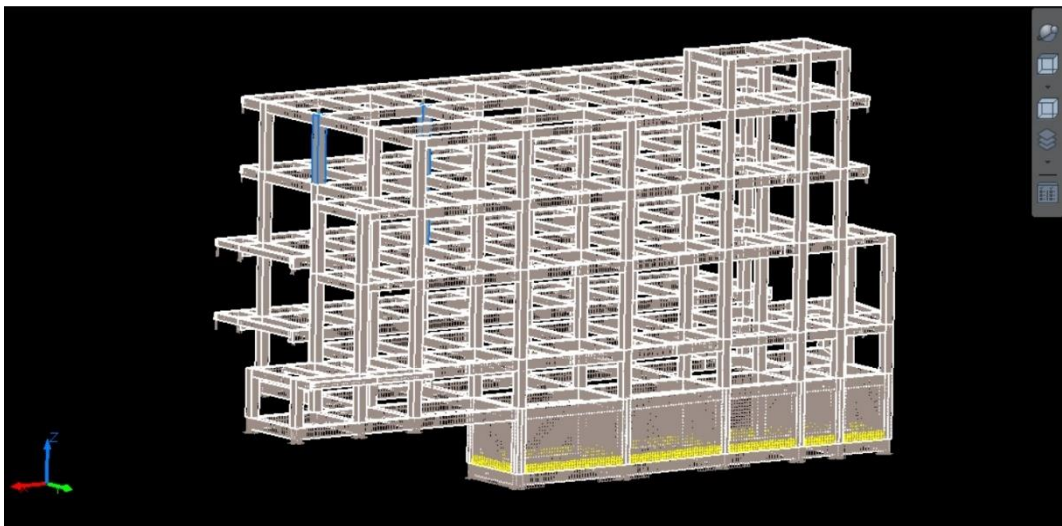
17 Denah Struktur Bawah dari Cubicost TAS
